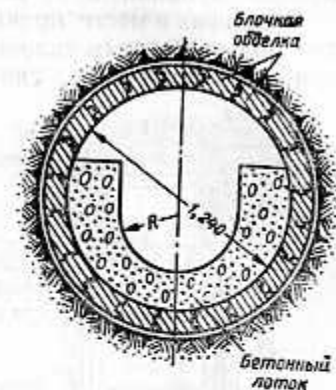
Конструкция туннеля из блоков с бетонным лотком
